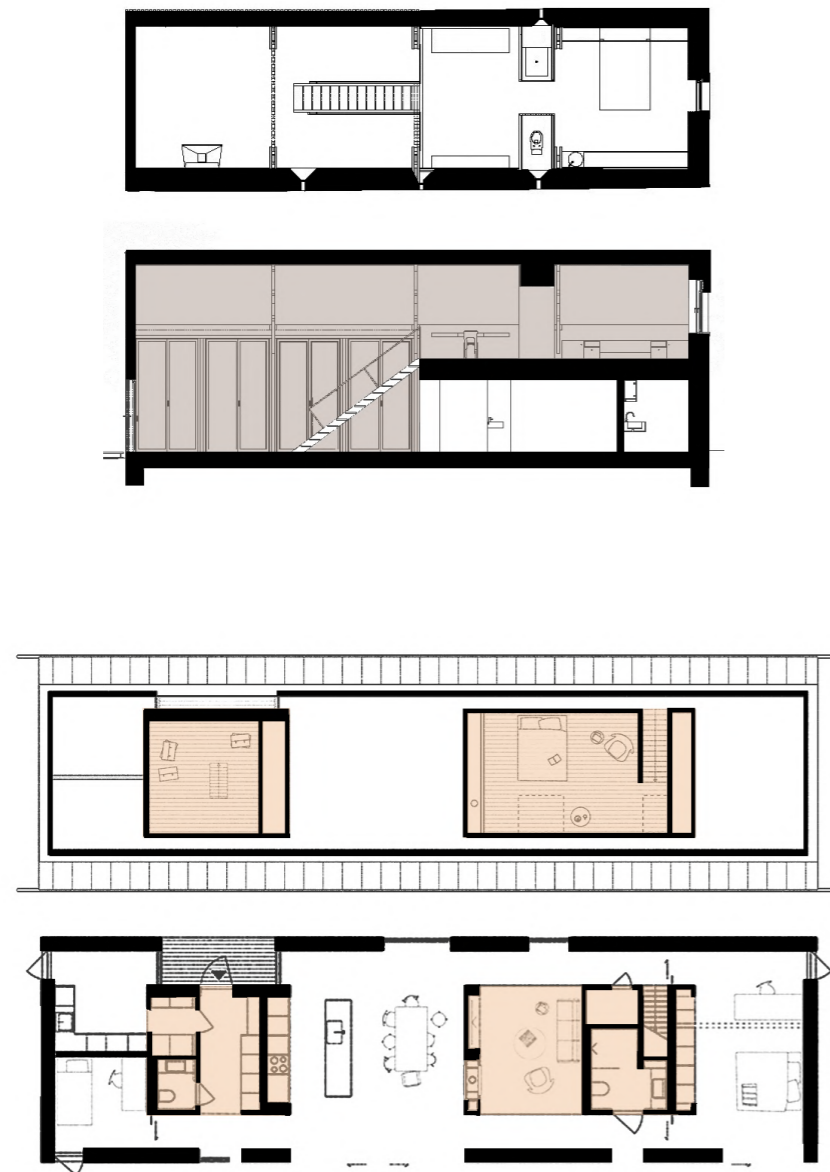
e 100 | Planta e secção do projeto para a reconversão do Palheiro em Cortegaça de João Mendes Ribeiro. (desenhos manipulados a partir da fonte: www.archdaily.com).
